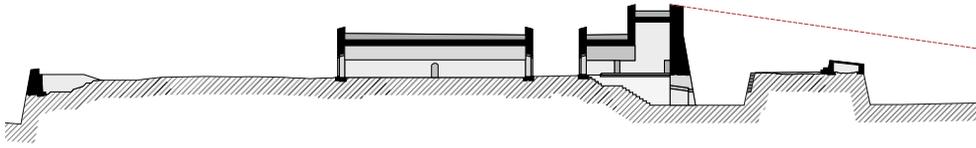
Perfil seccionado 1-2 / Elaboración propia.
